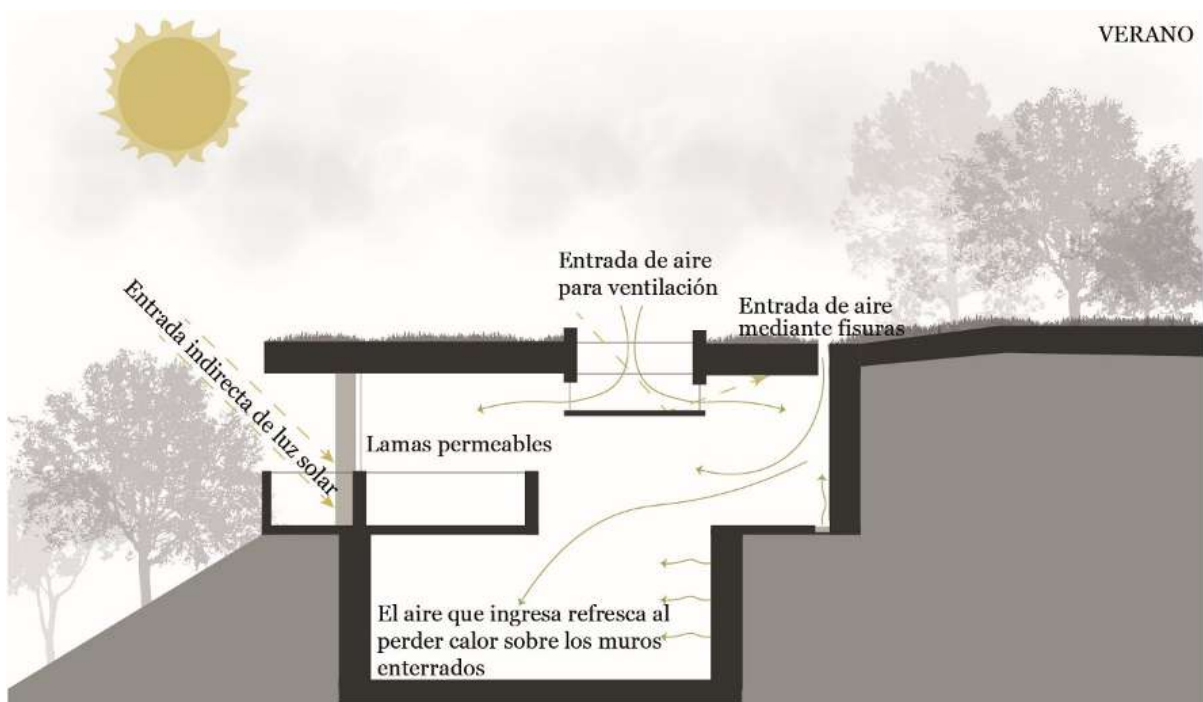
Zona de administración: Ingreso de luz en verano a través de lamas de madera y ventilación mediante fisuras en cubierta. Elaboración propia.
